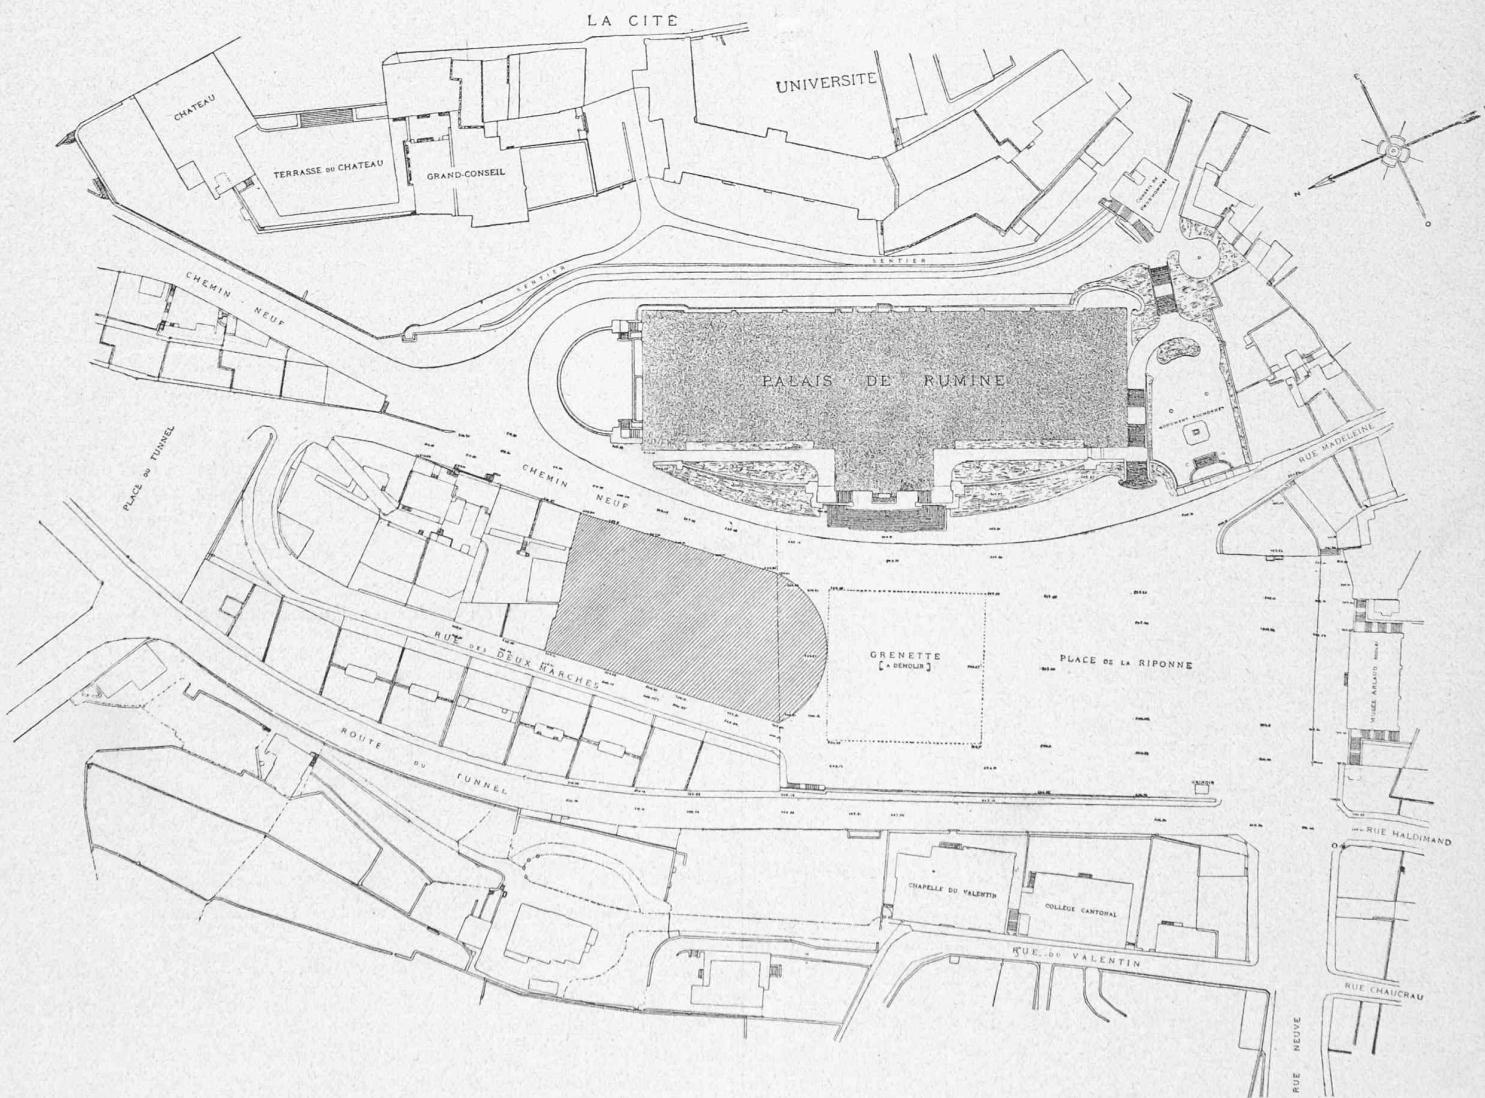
Plan de situation du bâtiment projeté pour la Grande salle sur la place de la Riponne, à Lausanne. — Echelle : 1 : 2000.
